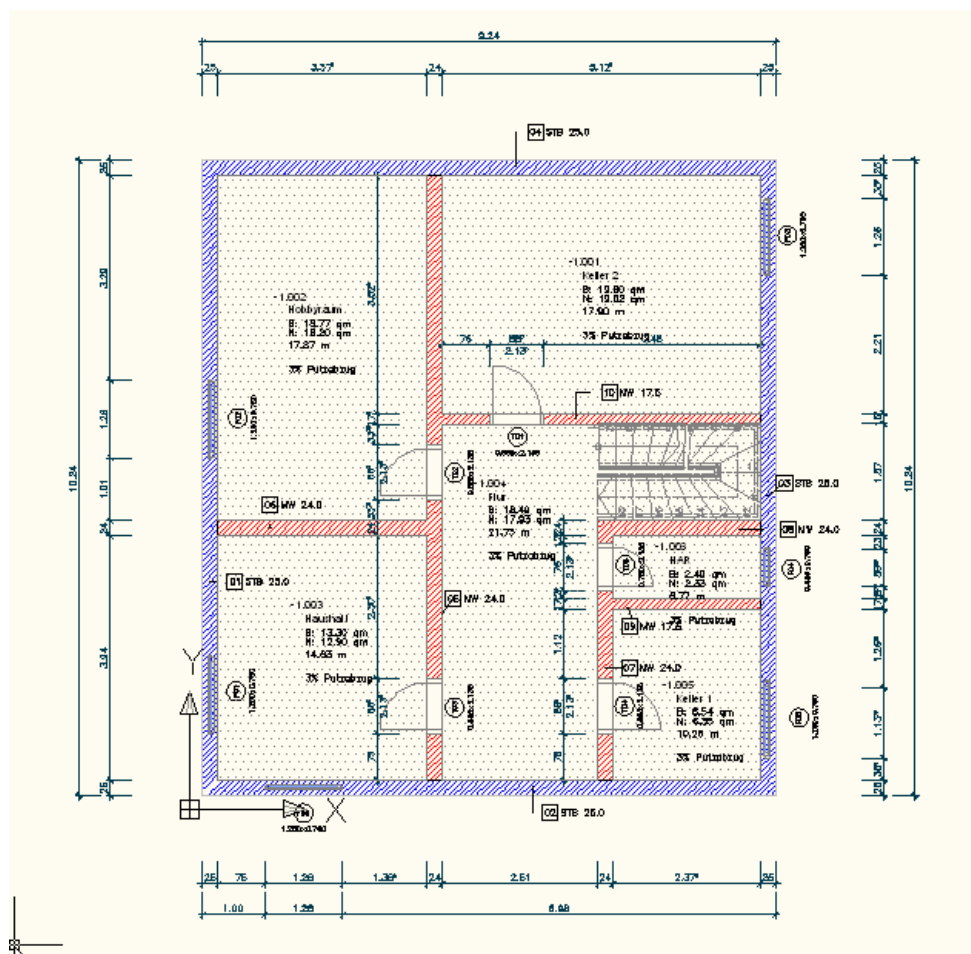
Beispielprojekt - Grundriss Kellergeschoss
